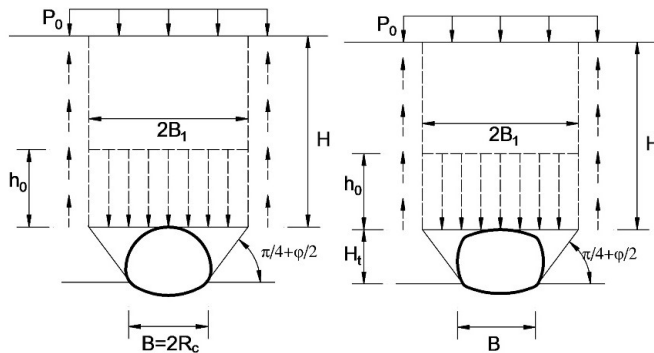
Расчетная схема для расчета вертикальной нагрузки на обделку
